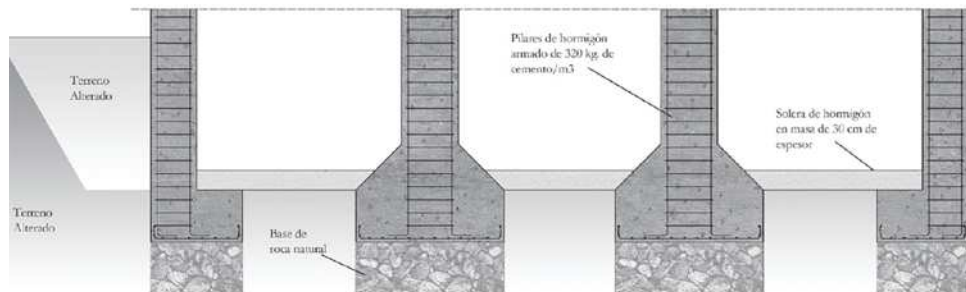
Sección de la cimentación del silo. Fuente: Planimetría de los autores.
